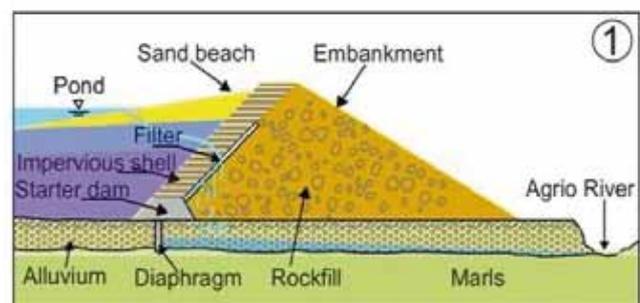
Planta y sección transversal de la presa de Aznalcóllar
